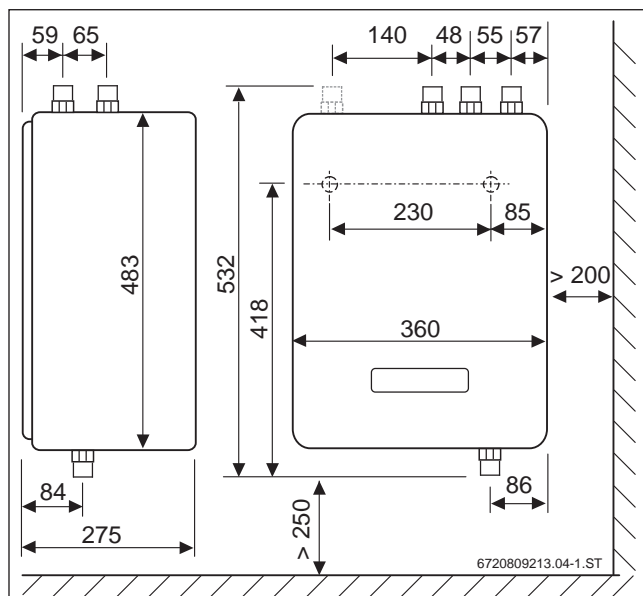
Abmessungen Frischwasserstation (Maße in mm)
